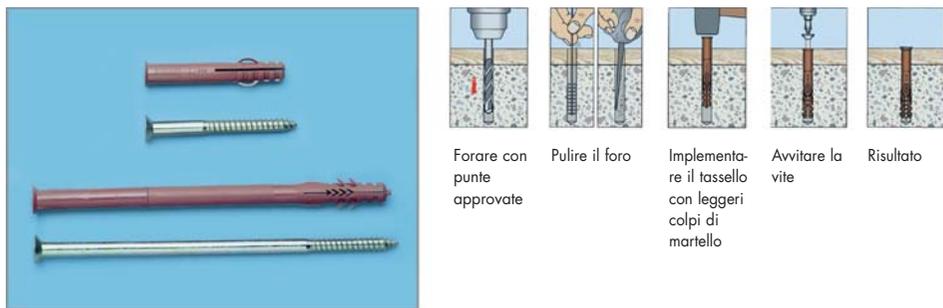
montaggio del tassello per serramenti Würth WE, destinato a fissaggi in calcestruzzo
